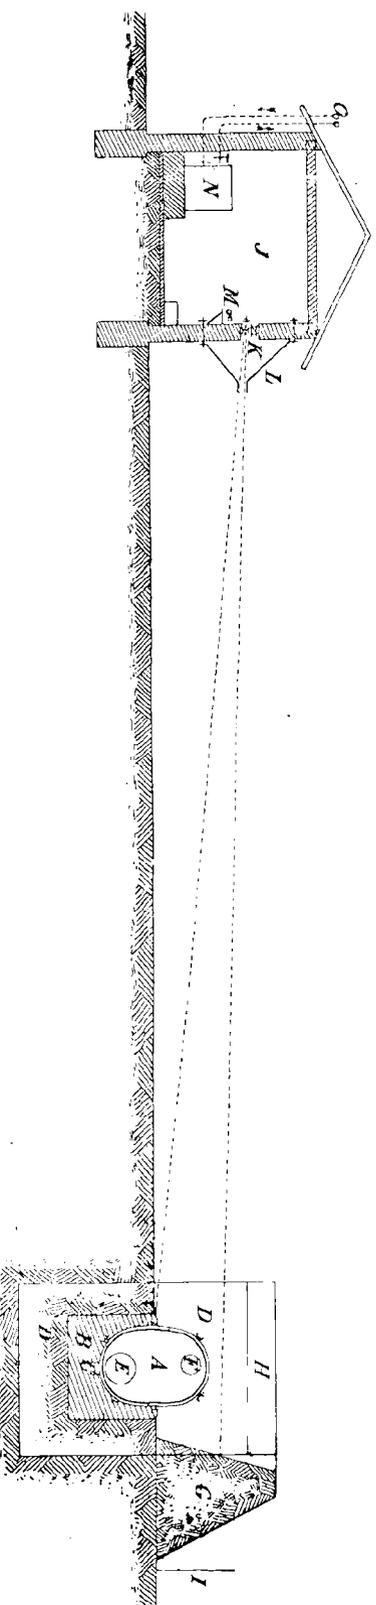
Coupe en travers du siège d'essai des explosifs.
